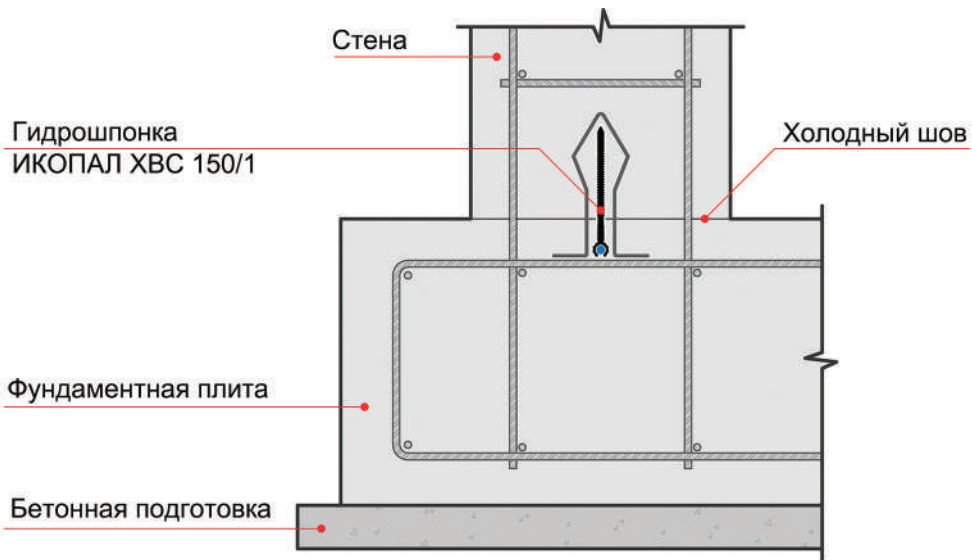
Герметизация холодного шва между фундаментной плитой и стеной
